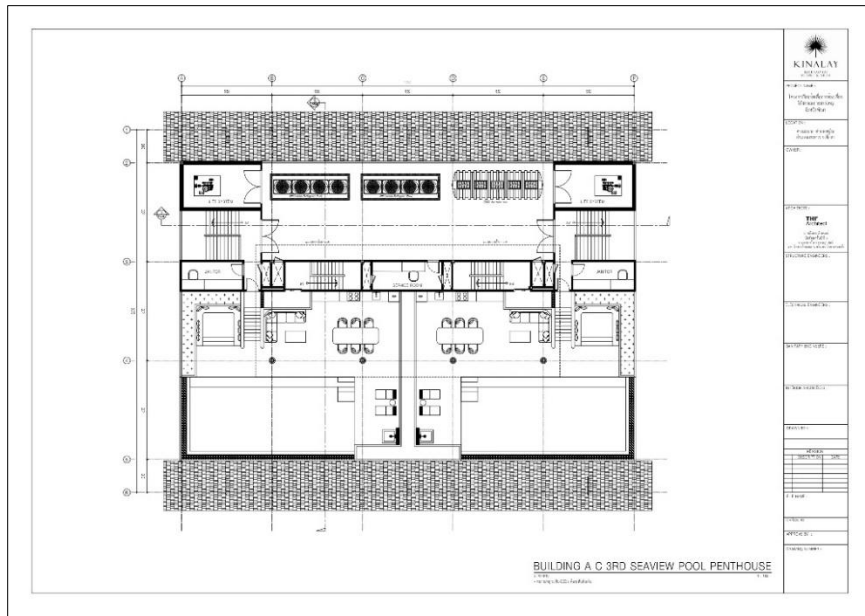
ผังบริเวณ The Building type A,B
